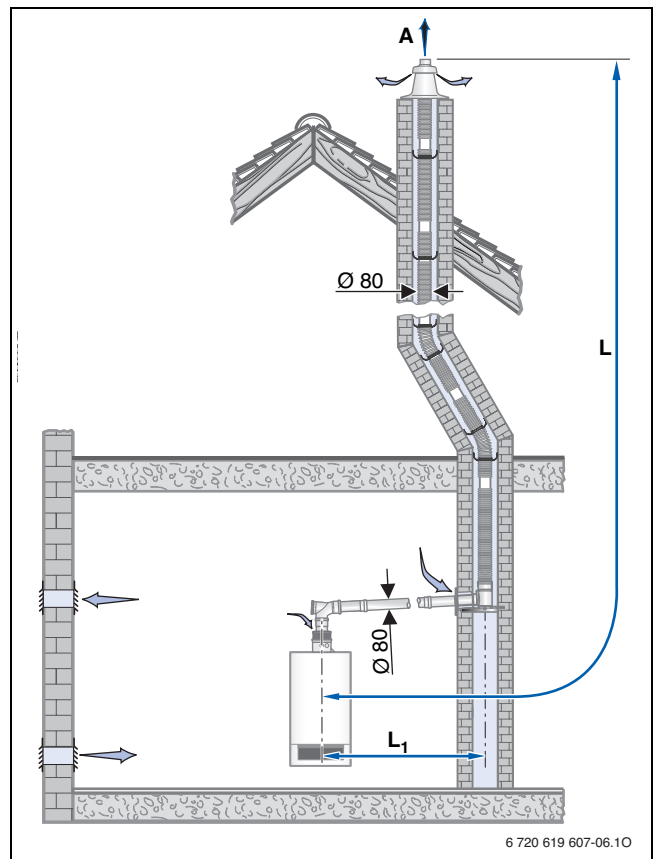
Montagevariante mit dem Bausatz GA + UB-flex
